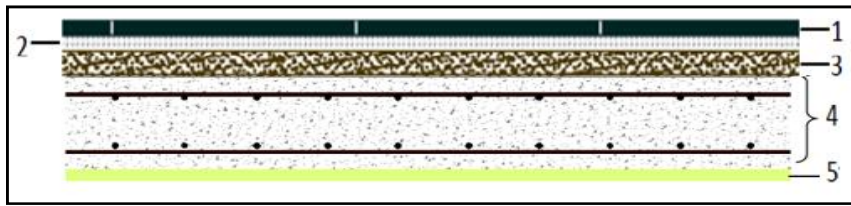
Composants d'un plancher étage courant dalle pleine.
